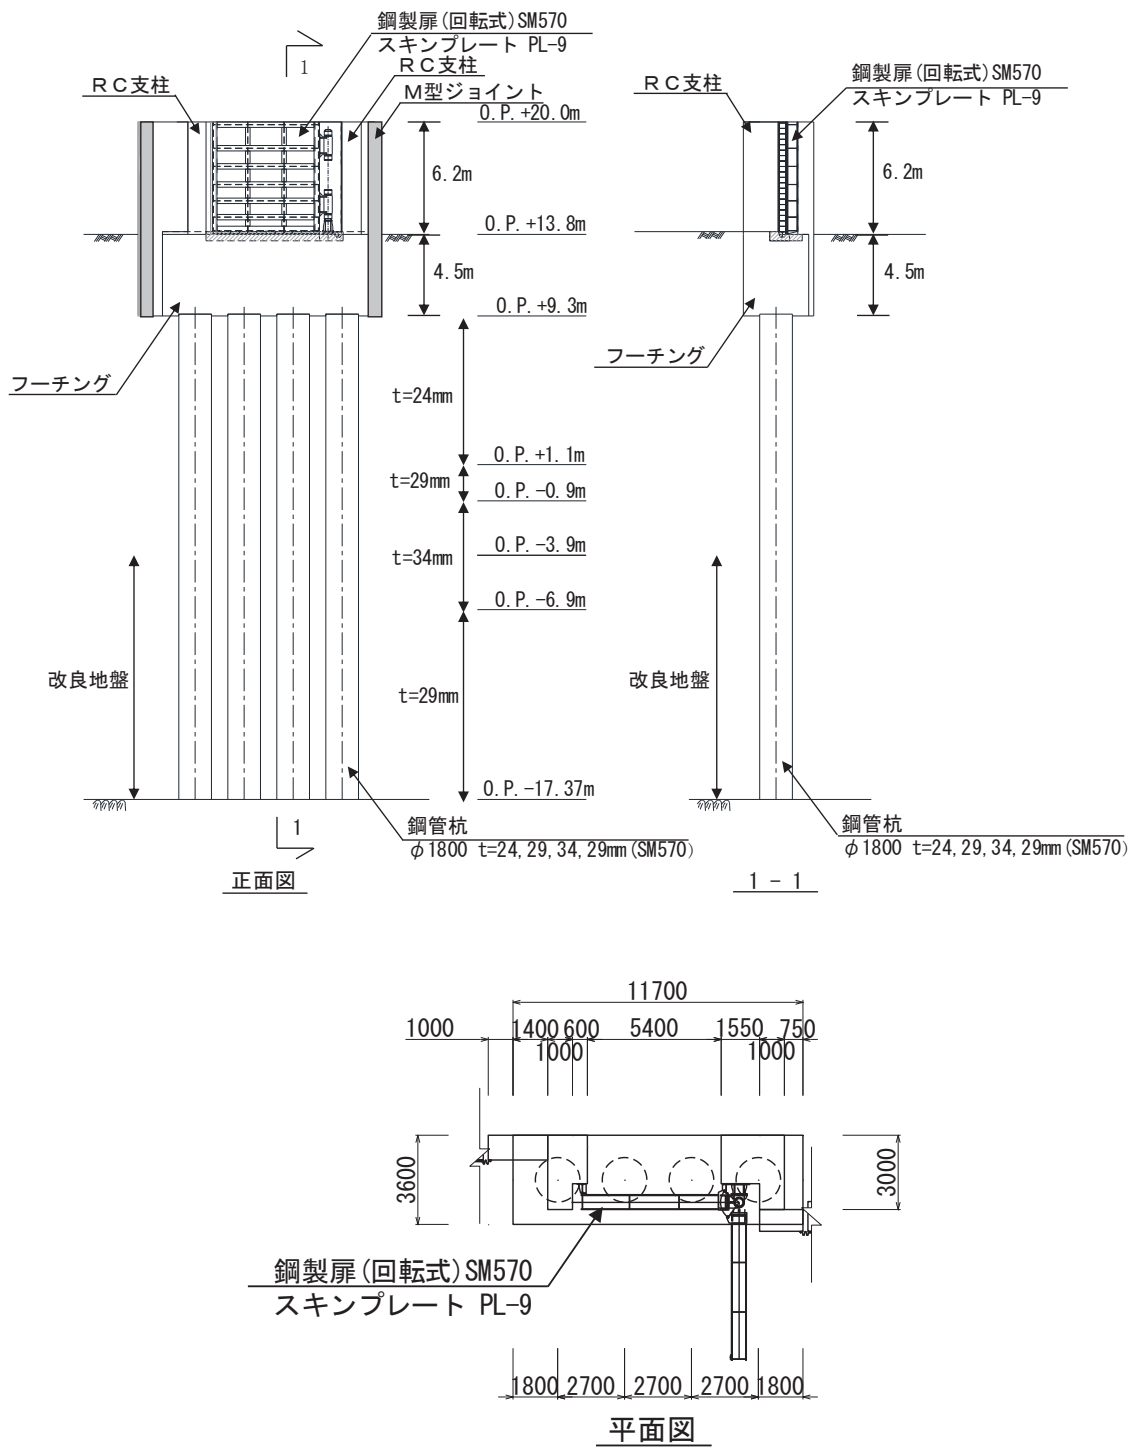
鋼製扉 3 の構造図 (正面図及び断面図, 平面図)
